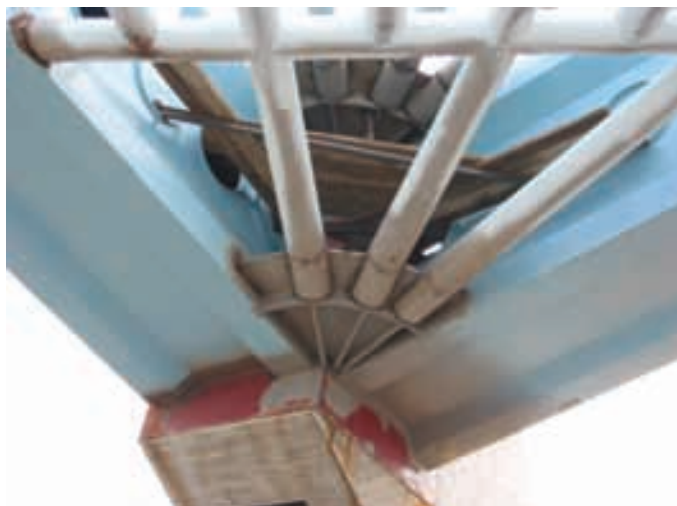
Montaje y conexión de la pieza de unión de las barras en una de las esquinas del voladizo.
